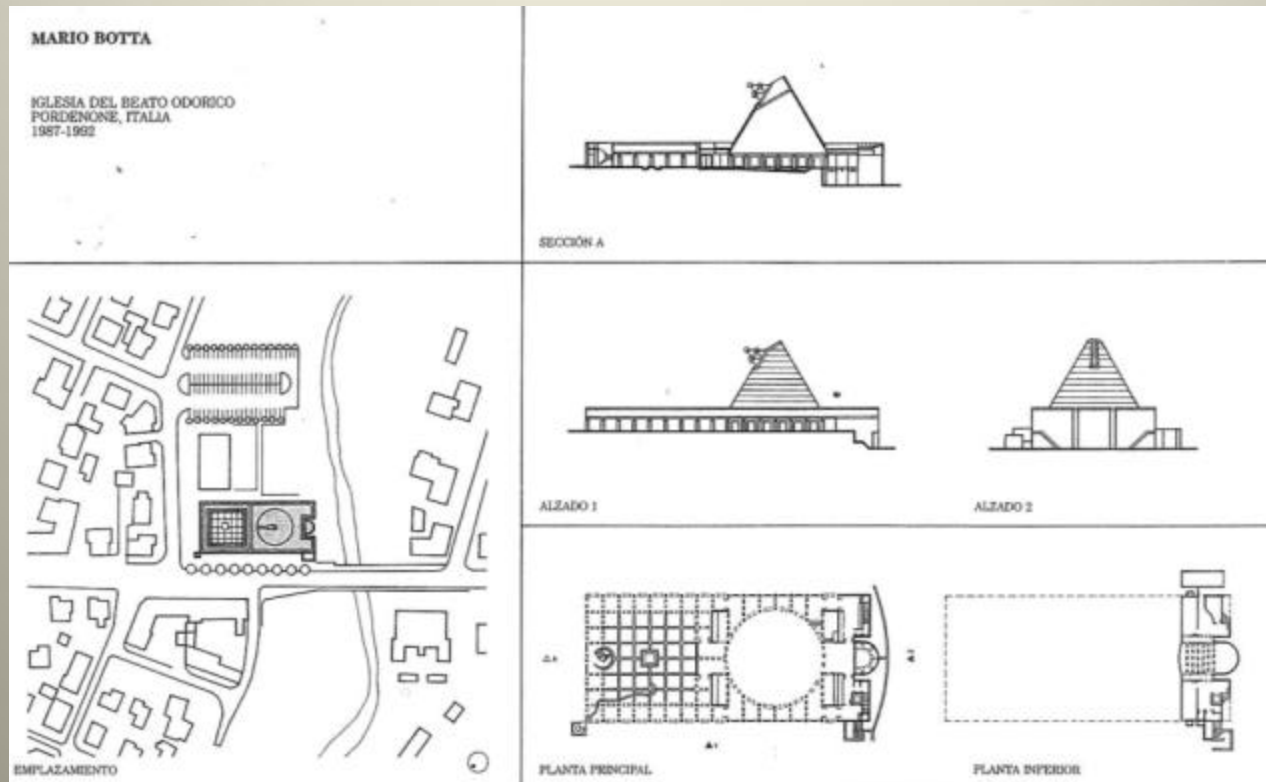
Implantação, Planta, Corte e Elevação - Igreja do Beato Odorico. (pág. 42)
